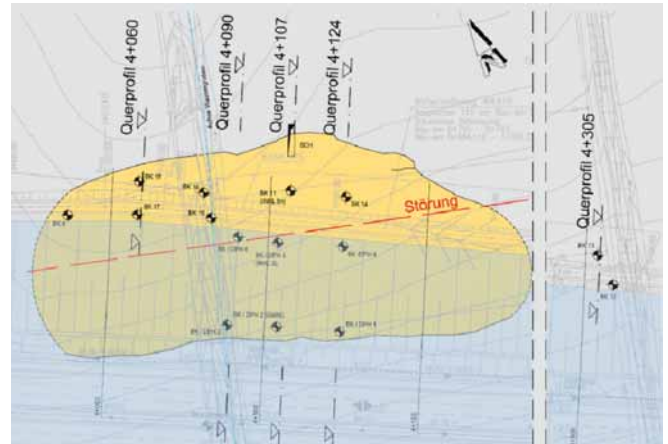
Lageplan mit Verlauf der maßgebenden Störung.
